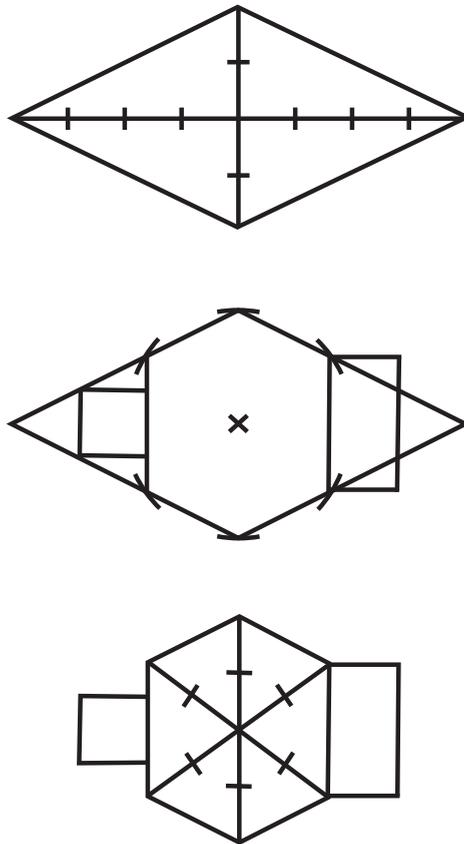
, Einmessung des Grundrisses, Rekonstruktion
